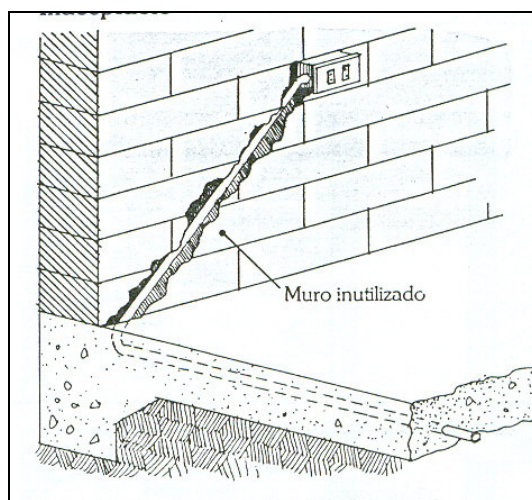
Disposição das instalações elétricas – inaceitável, inutilização da parede (VARGAS, 1987).
